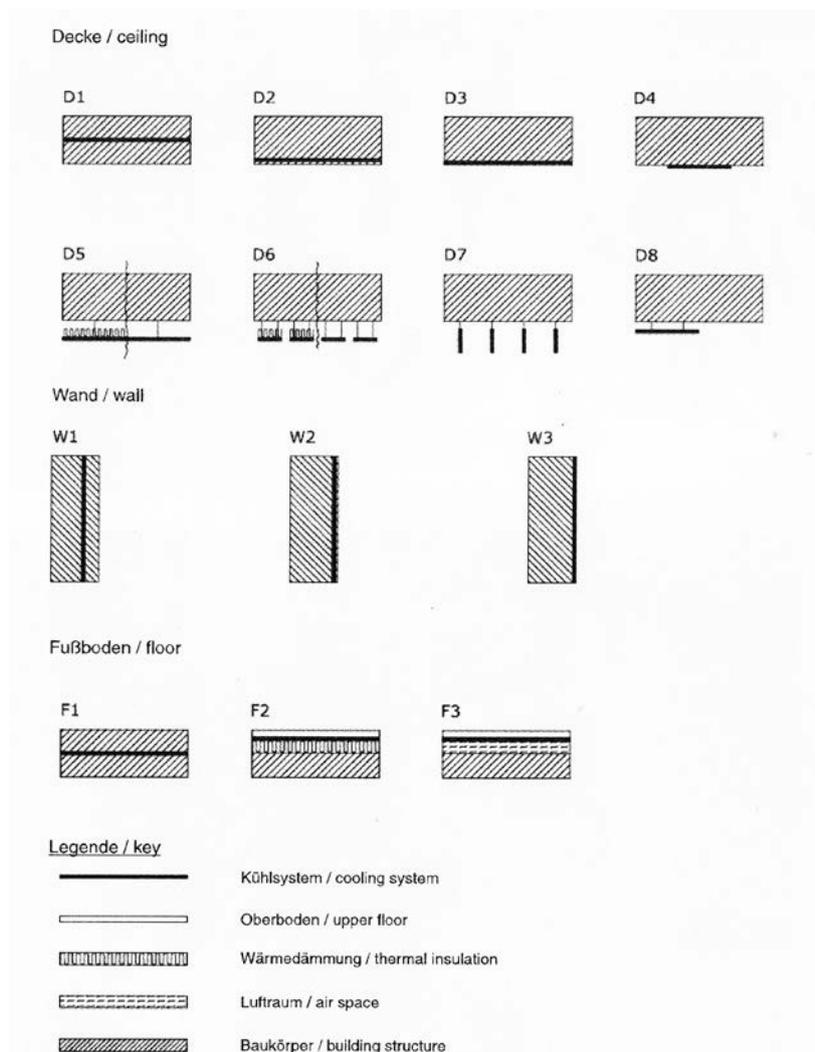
typische Bauarten (Baukörper; Kühlsystem, Wärmedämmung)
